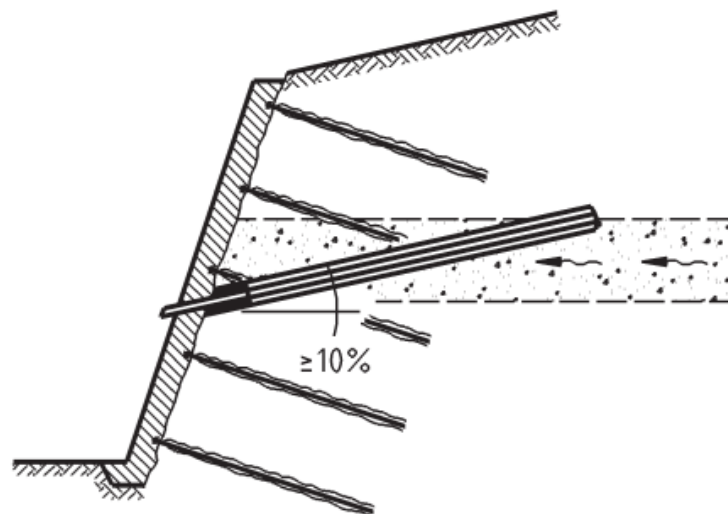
Sistema de drenaje de tipo dren californiano (Fuente: Execution of special geotechnical Works – Soil Nailing (BS, 2010))
